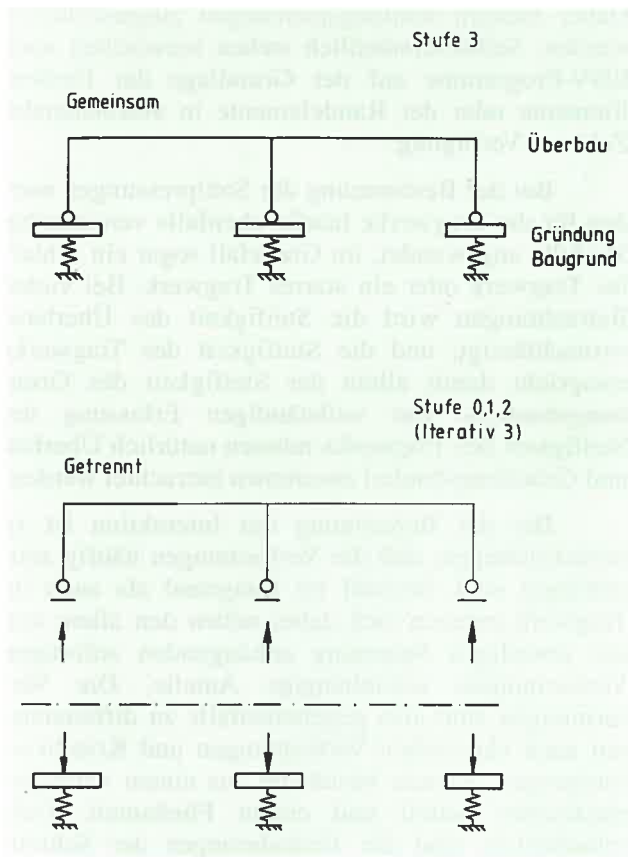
Modellierung Tragwerk-Gründungskörper/ Baugrund bei Einzelgründungen
